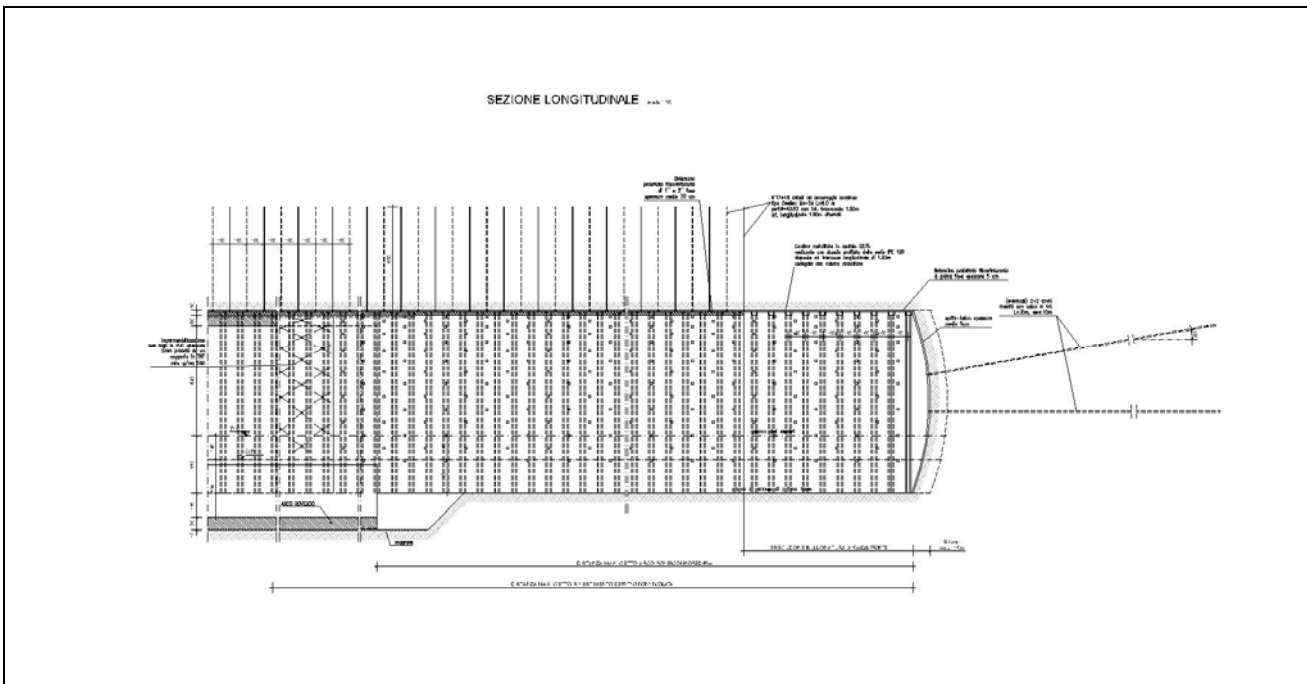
Sezione di scavo tipo GD-A2 - Sezione longitudinale
